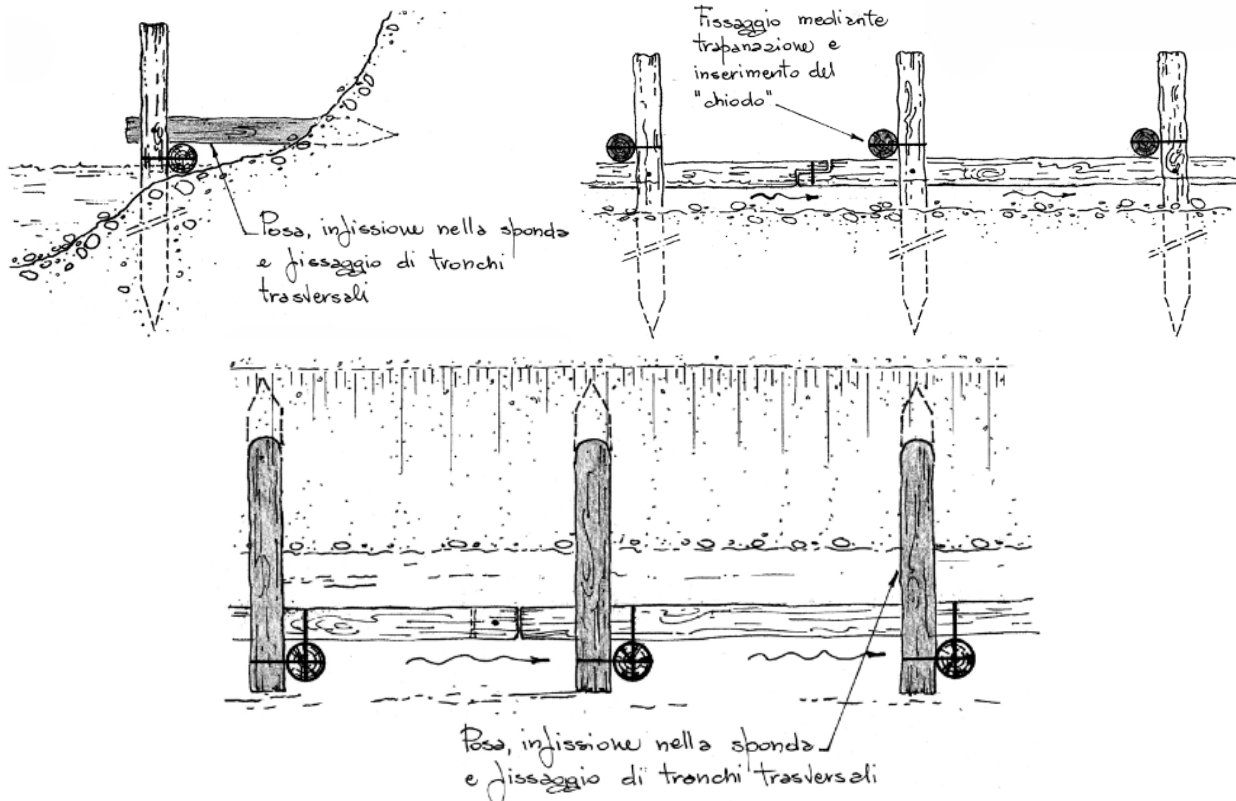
Schema di realizzazione di palificata viva spondale con palo frontale - Fase 1: sezione (sx) e prospetto (dx). Fonte: Regione Lazio, AIPIN, 2000. Quaderni di cantiere del Manuale regionale dell'ingegneria naturalistica
